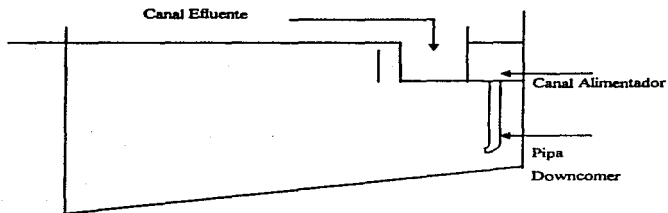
ALIMENTACIÓN PERIMETRAL
